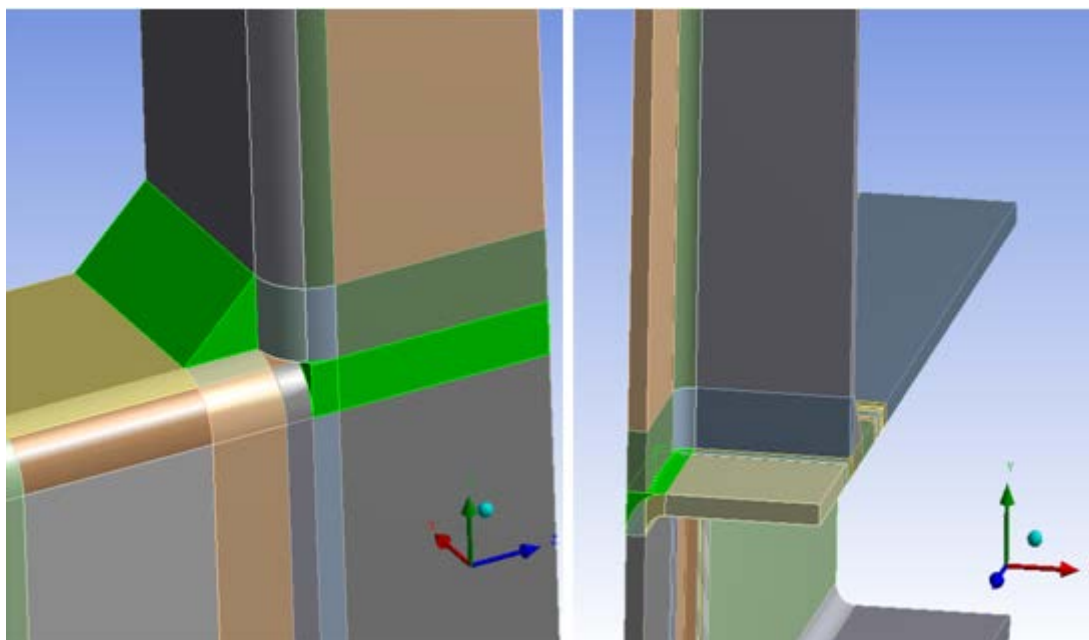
Modelo 3. Soldadura exterior e interior de la unión en T
